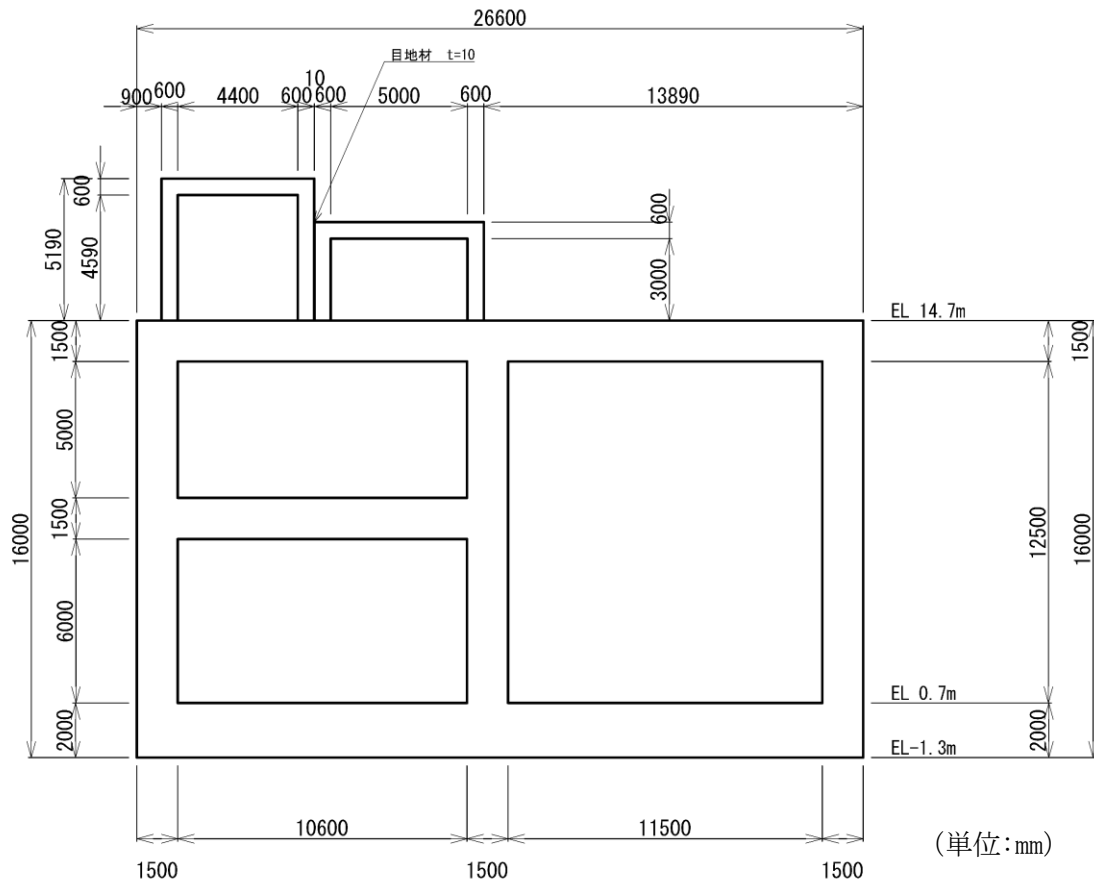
低圧原子炉代替注水ポンプ格納槽 断面図 (C-C断面)
